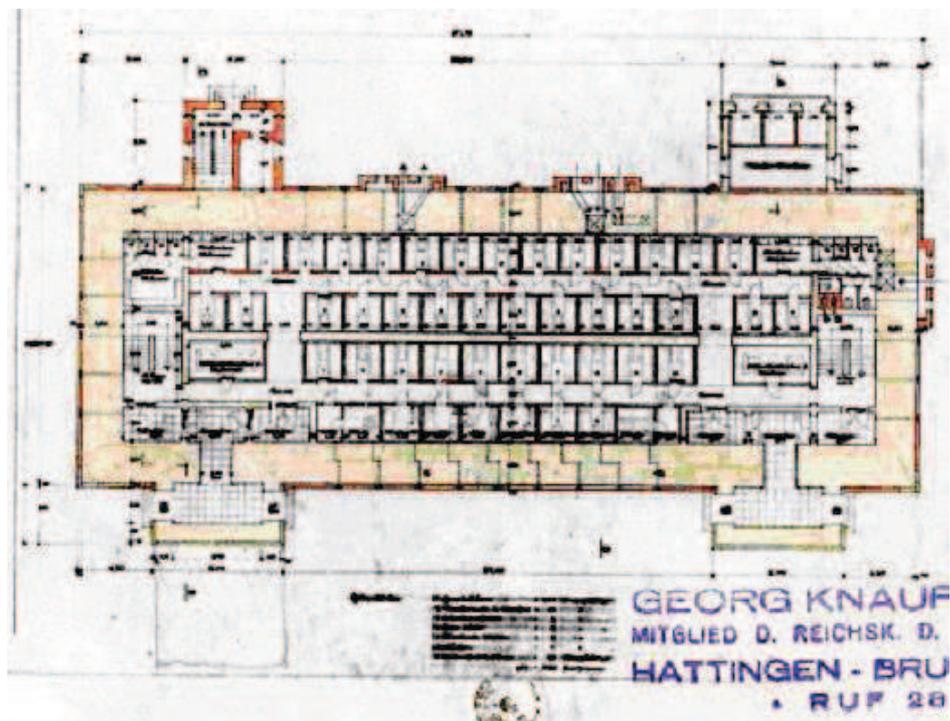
, Grundriss Erdgeschoss
